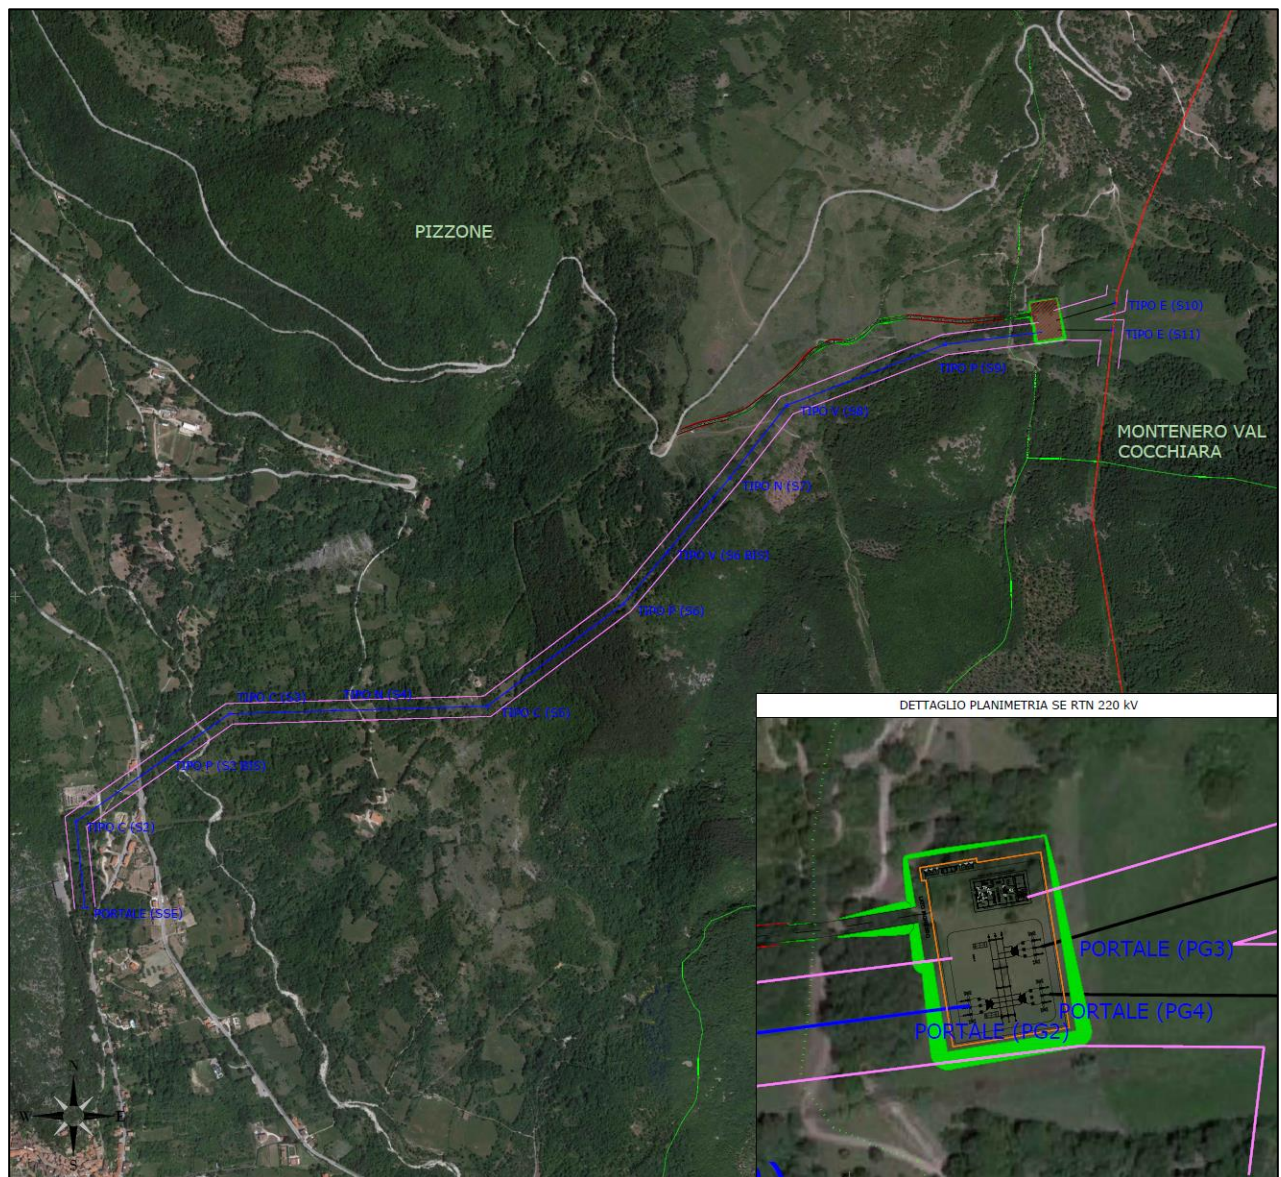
Inquadramento del layout di progetto su base ortofoto
